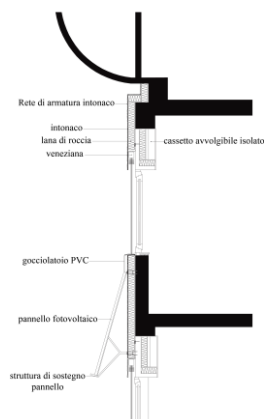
Sezione verticale con pannello solare facciata sud
